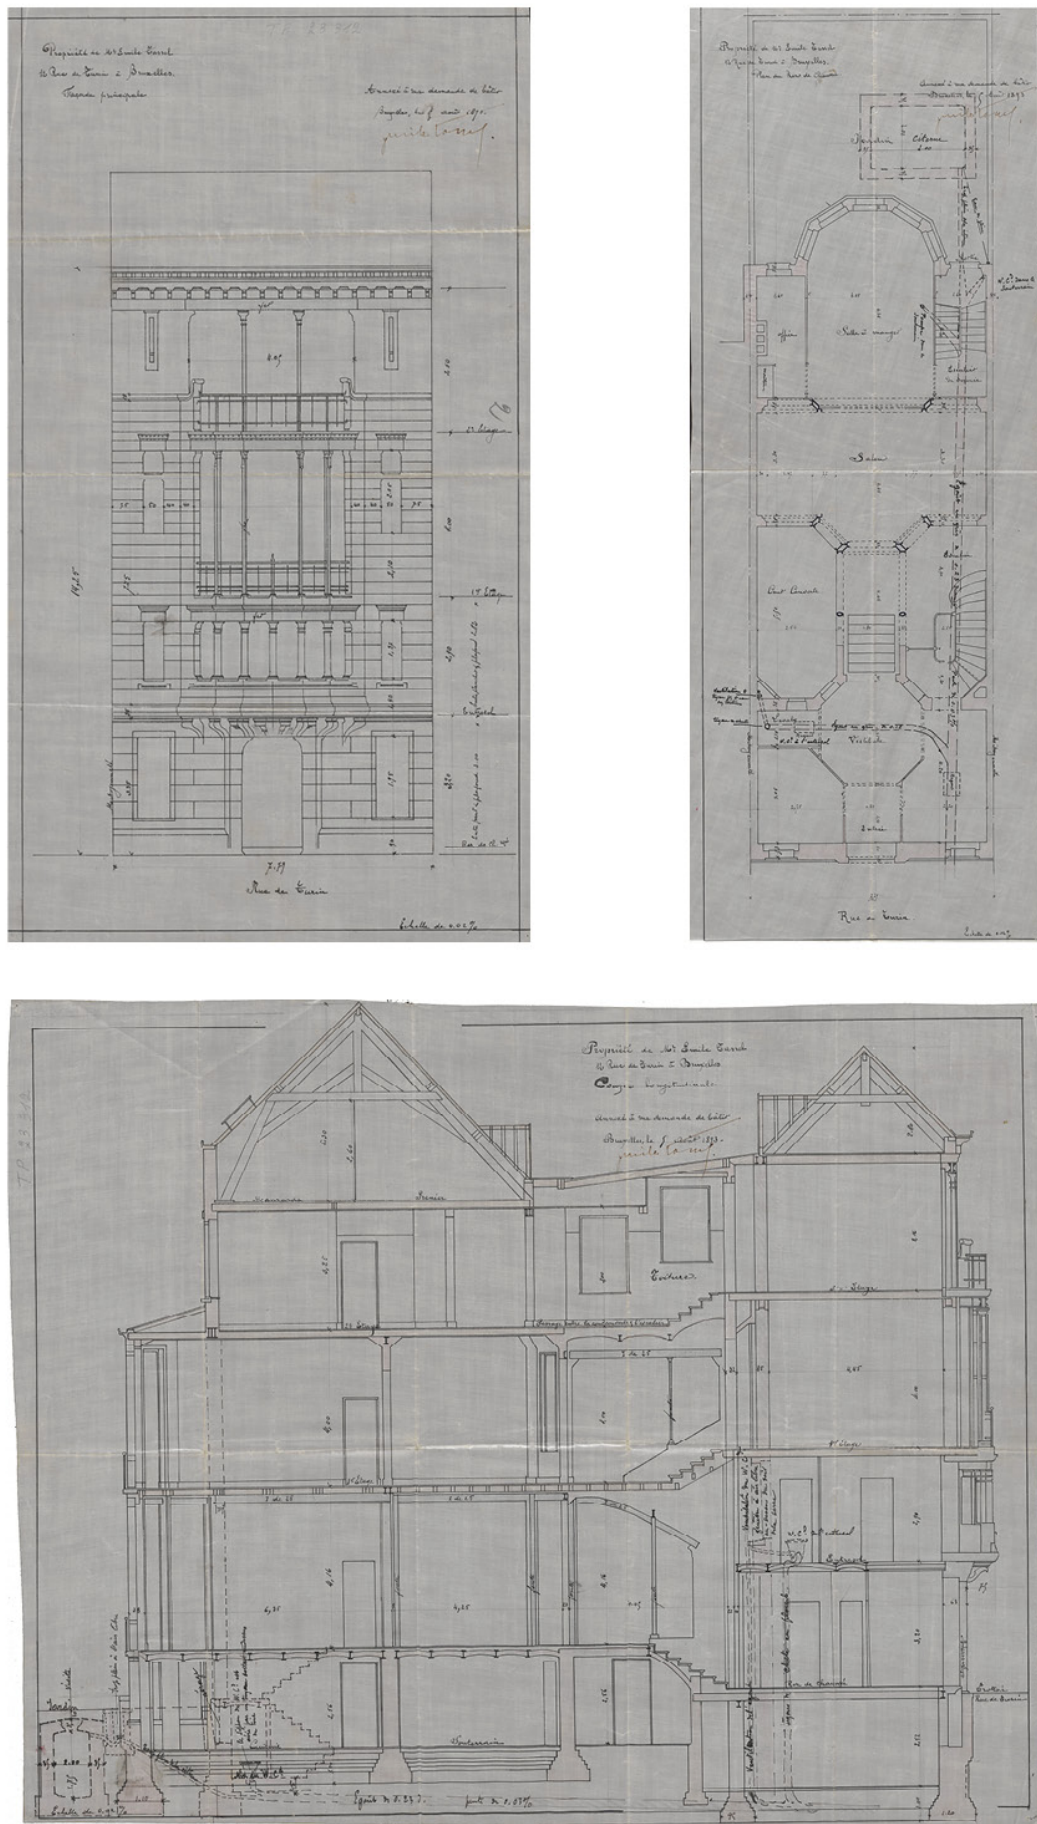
Hôtel Tassel, elevation, plan and section in the building permit application, 1894 [Archives Ville de Bruxelles]
